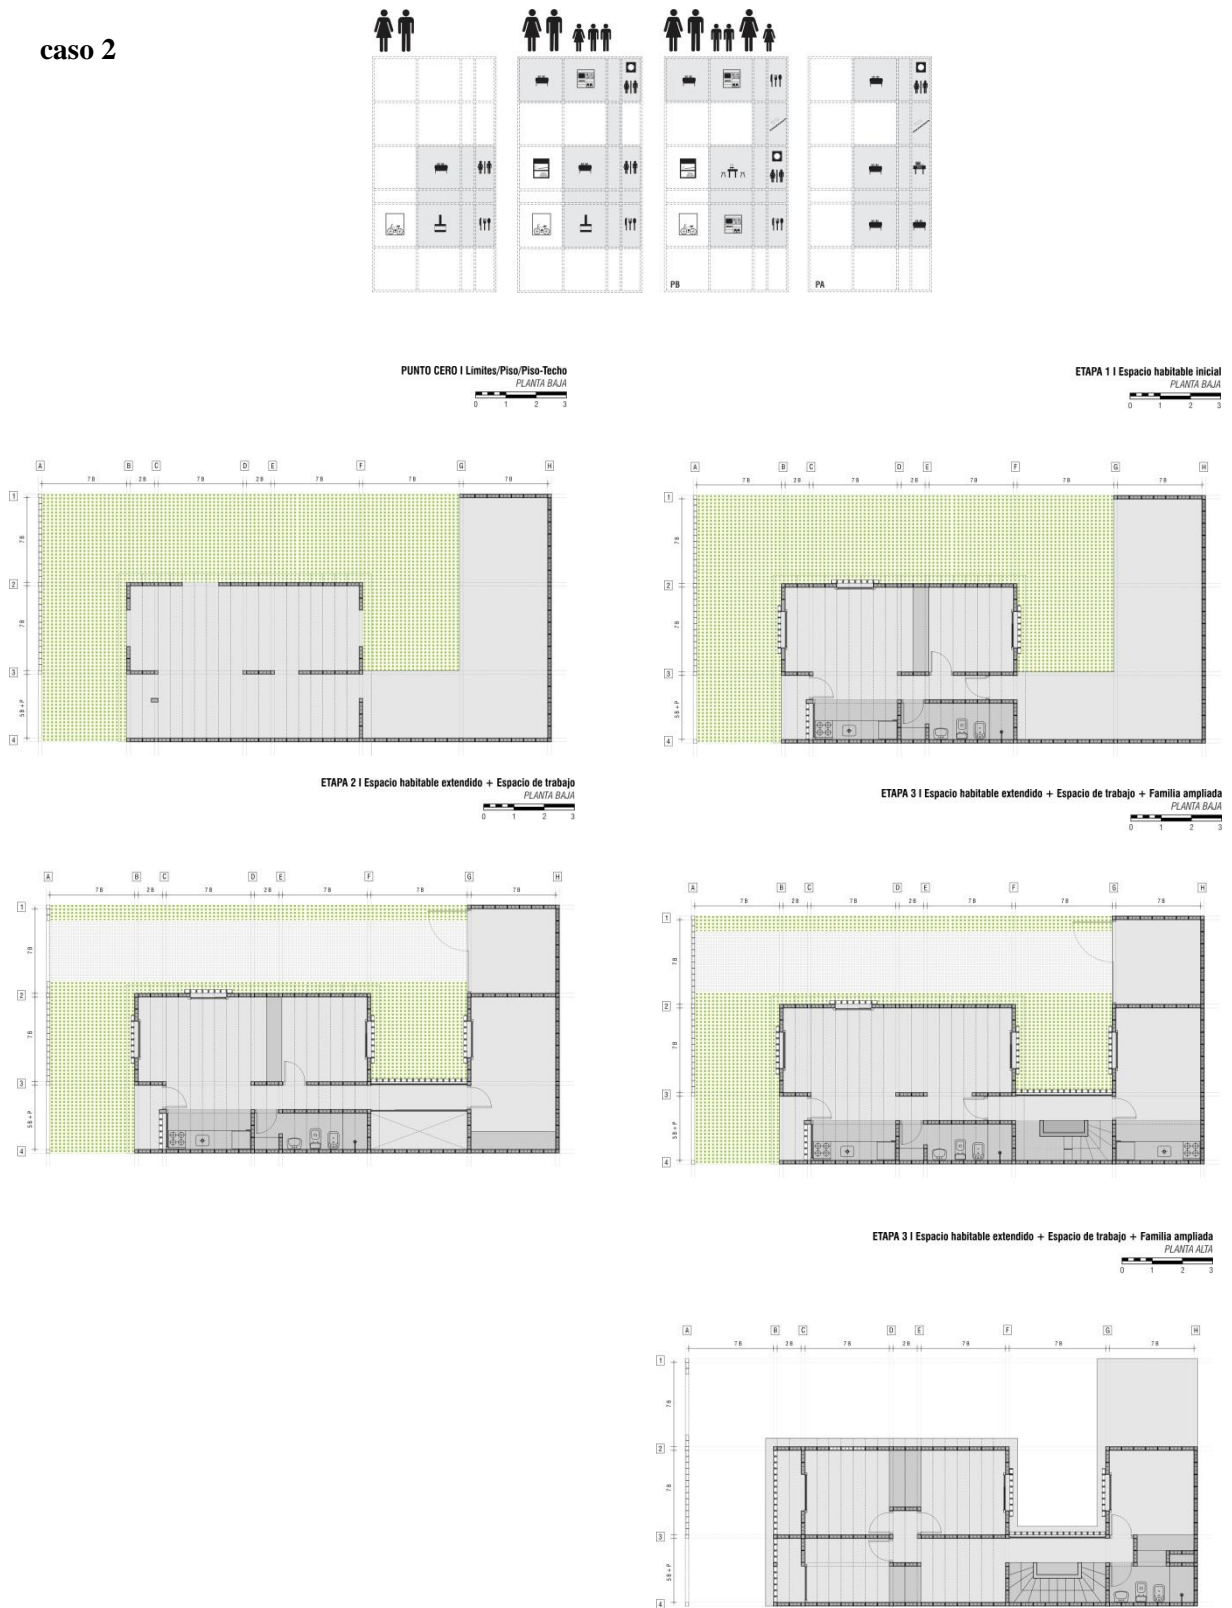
Caso 2. Plantas del desarrollo del plan de tránsito.
